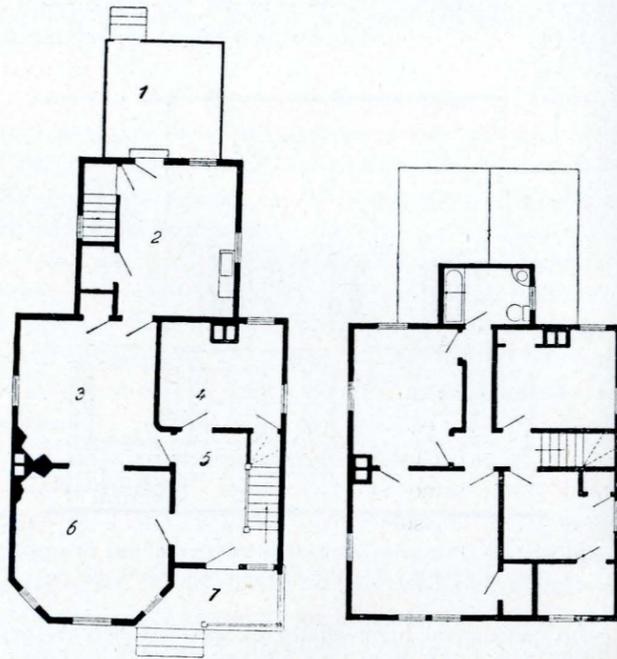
Pianta del piano terreno e del primo piano di una casetta costruita dalla « Maryland Steel Company ».
